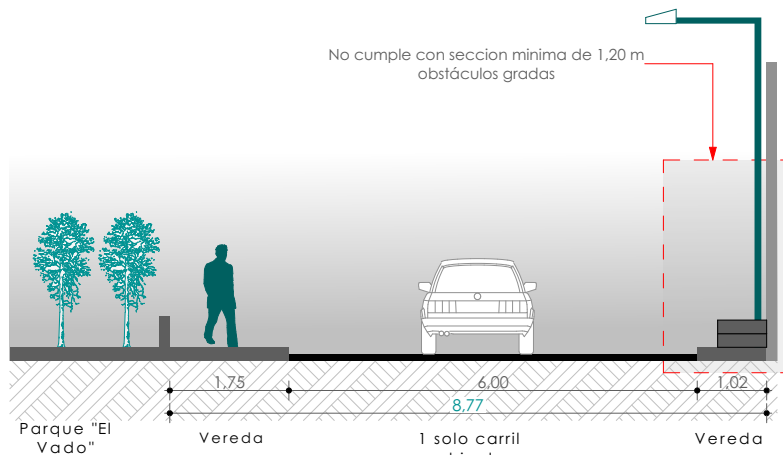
Sección S_04 calle Sucre. Imagen: propia
